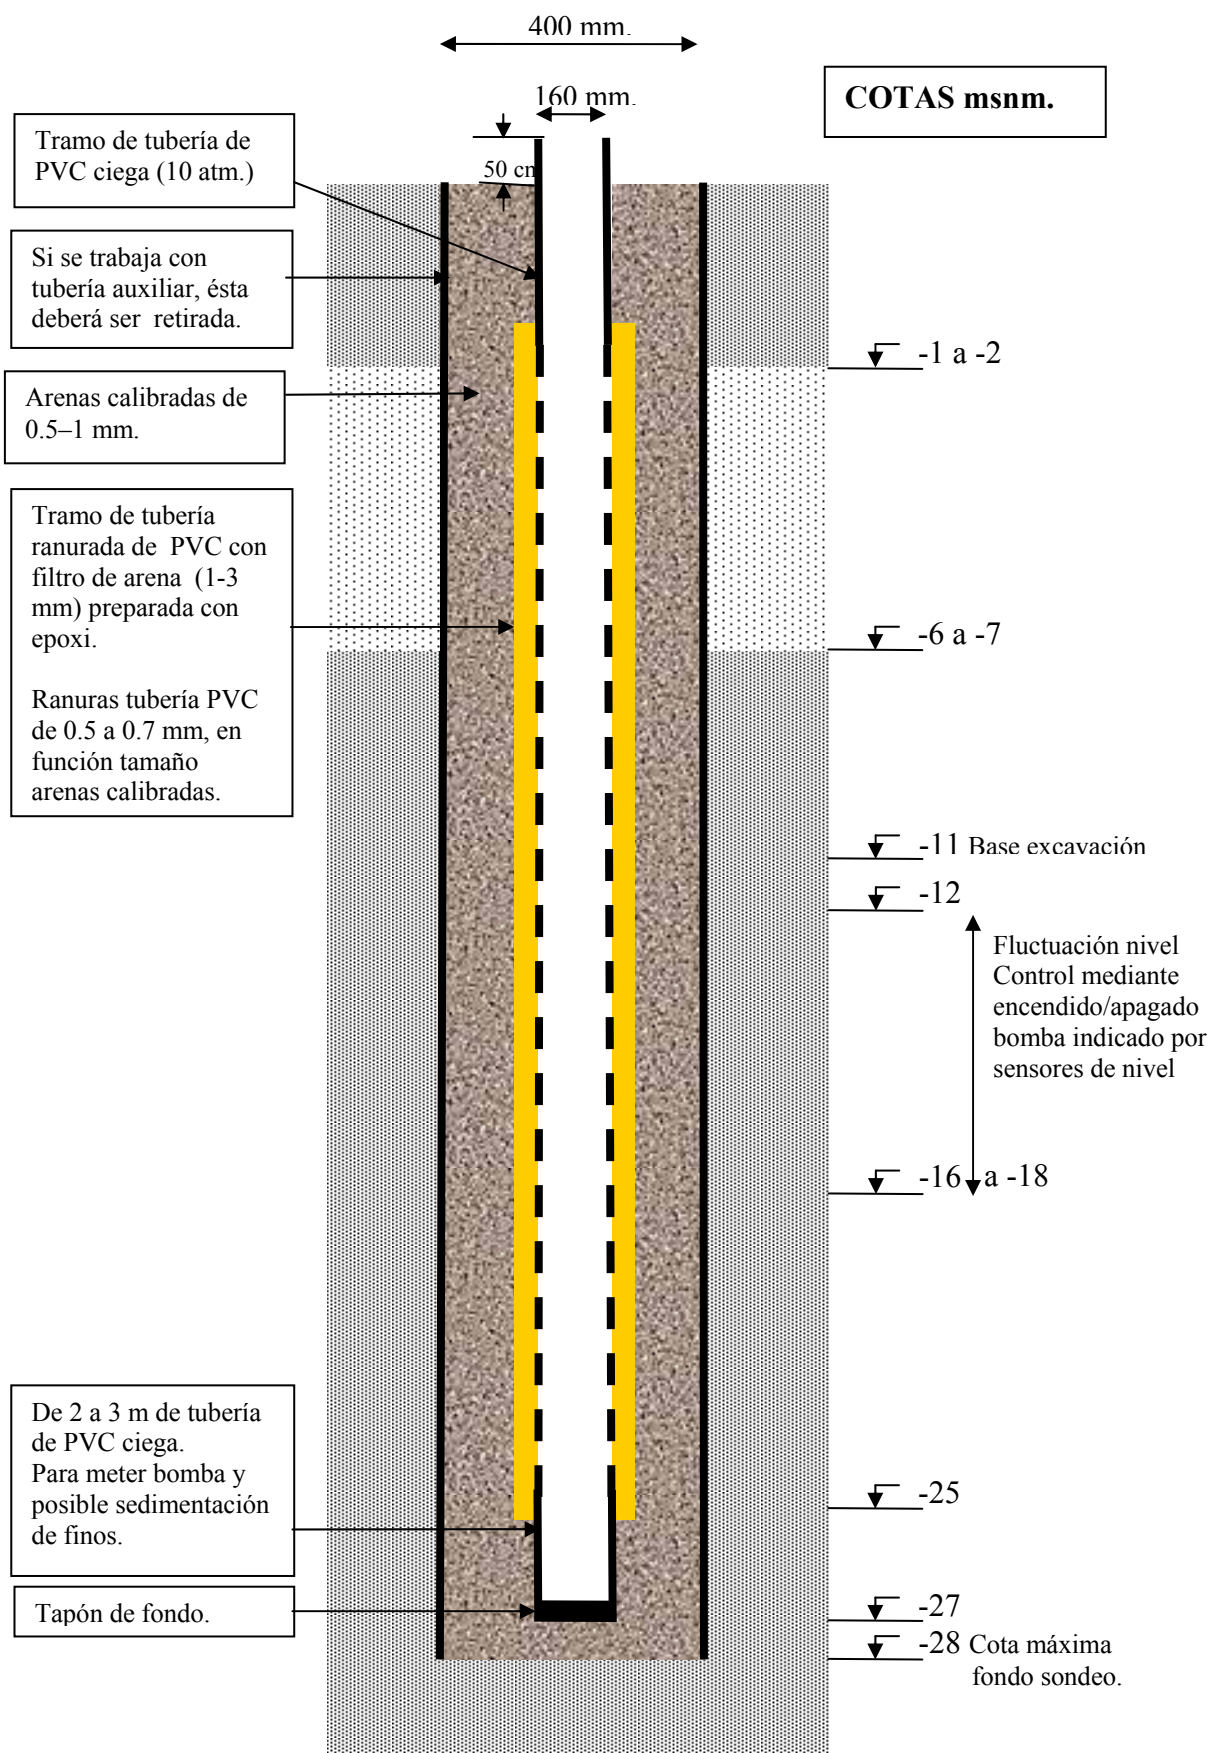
Esquema constructivo de los Pozos Sangradores. Variante con prefiltro de resina epoxi, en caso de no llevar ésta, las ranuras del tubo de PVC no deberían superar los 0.5 mm.
